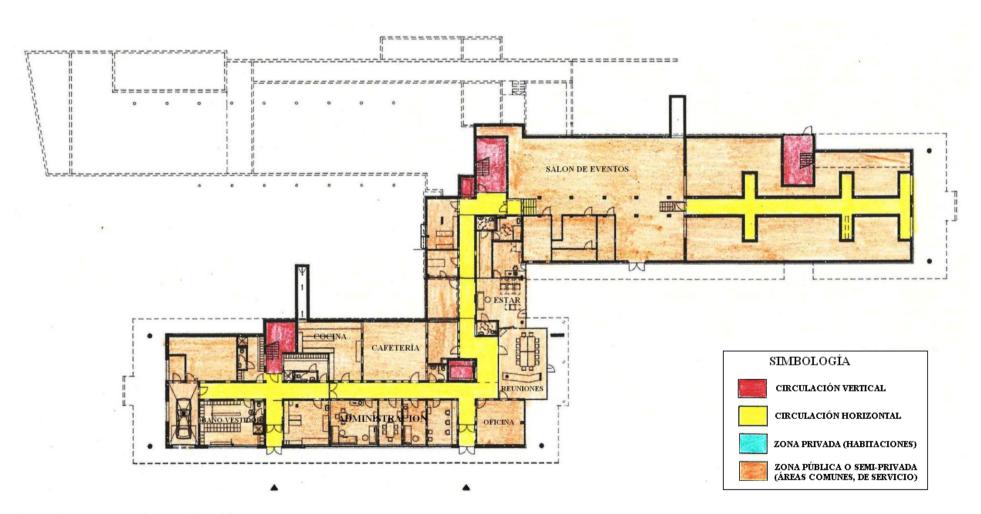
Planta baja del Asilo Gârtner + Neururer.
